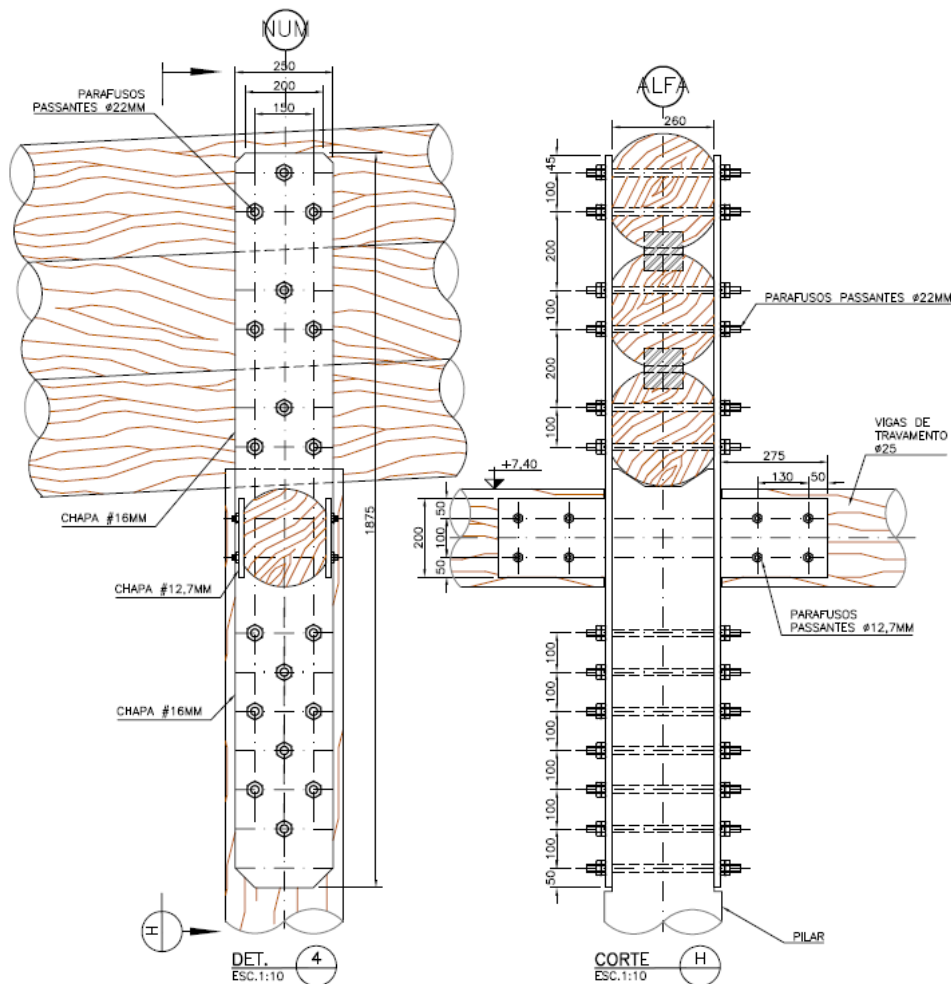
Detalhe da união entre as vigas compostas e os Pilares 2, 3, 4 e 5 do pórtico.
